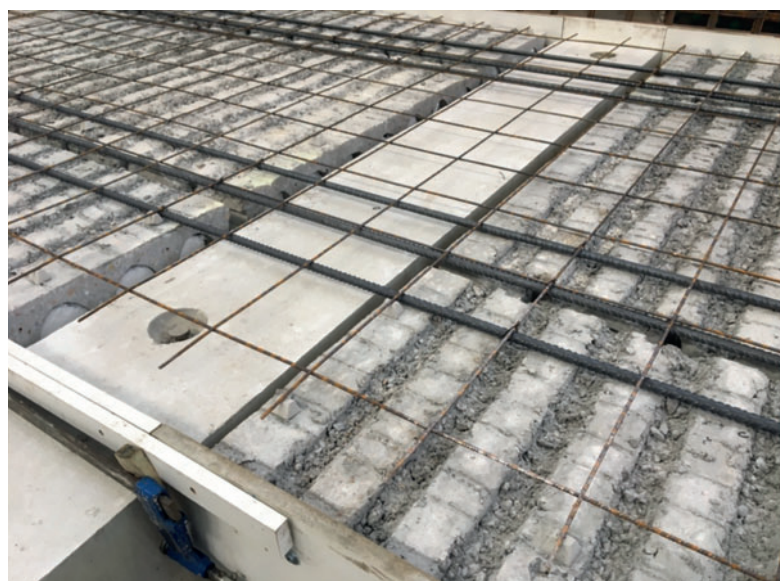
Перекрытие с использованием рифленых многопустотных плит до бетонирования верхнего слоя
